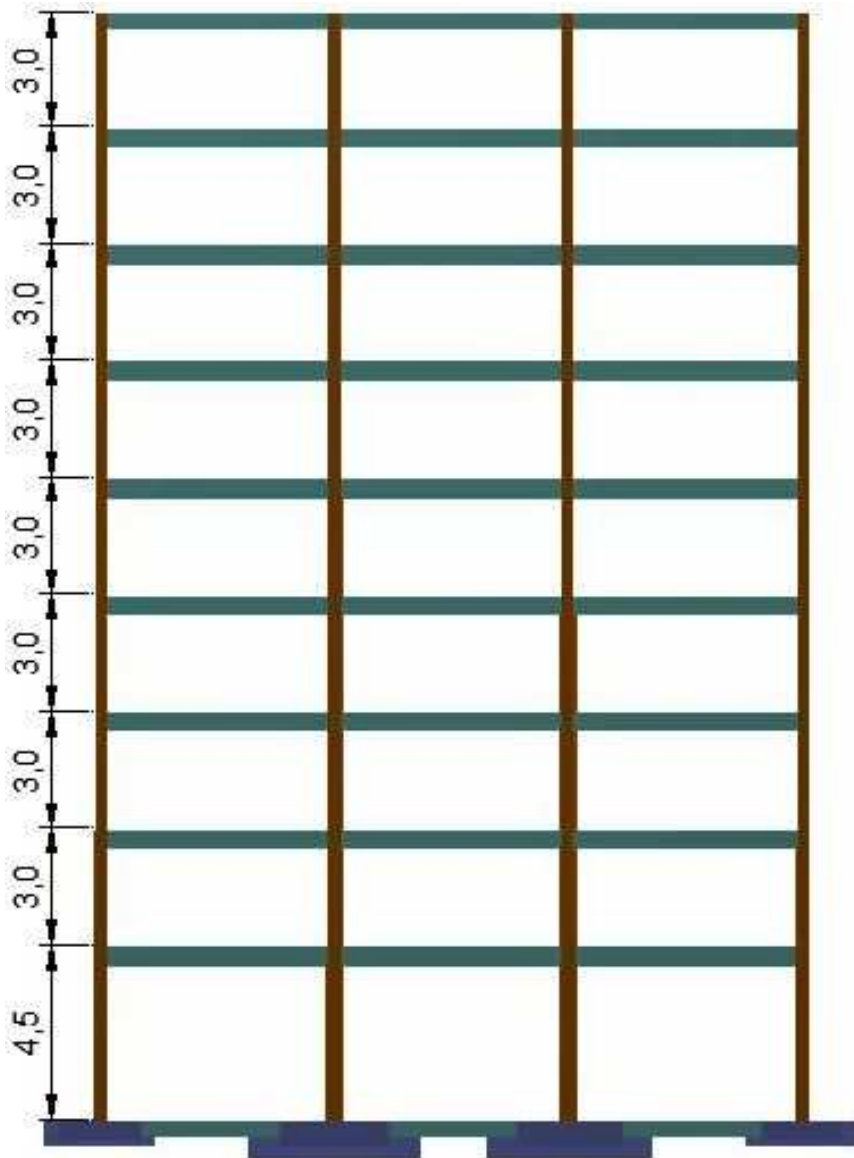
Vista en perfil. Edificio de 9 plantas.
